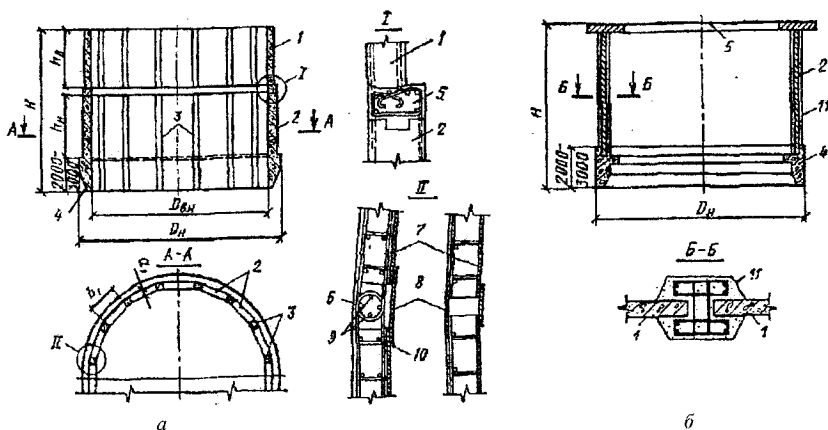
Конструкції опускних колодязів із плоских залізобетонних панелей (а, б):
